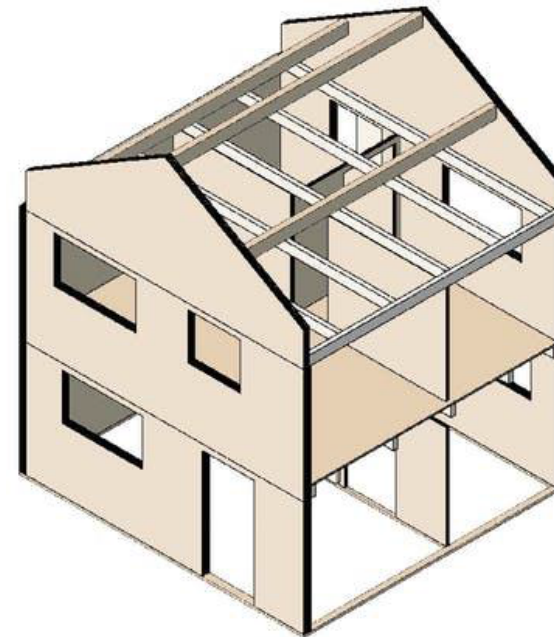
Cross Laminated Timber (Woneninhout, z.d.)
